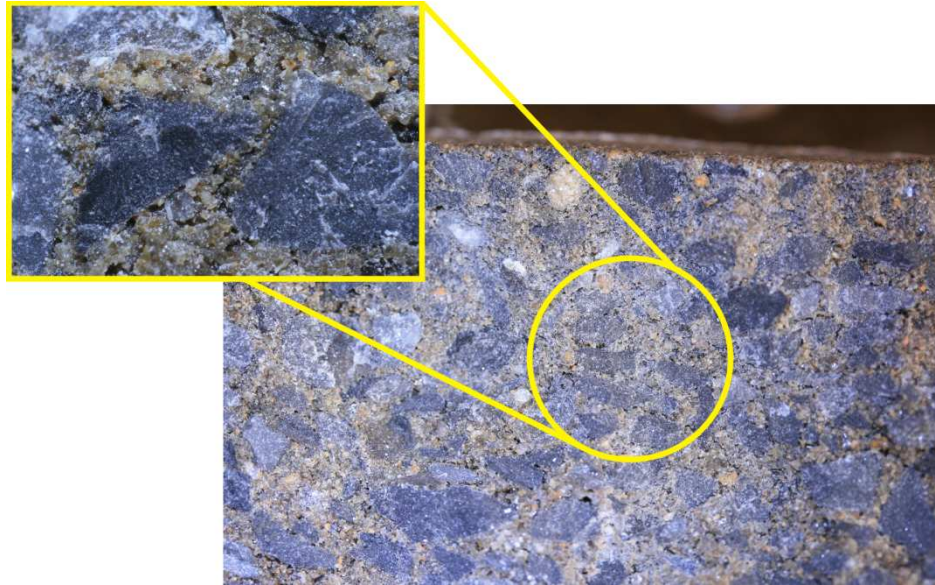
(Querschnitt einer Gussprobe mit der für die Maschine verwendeten Mischung)
